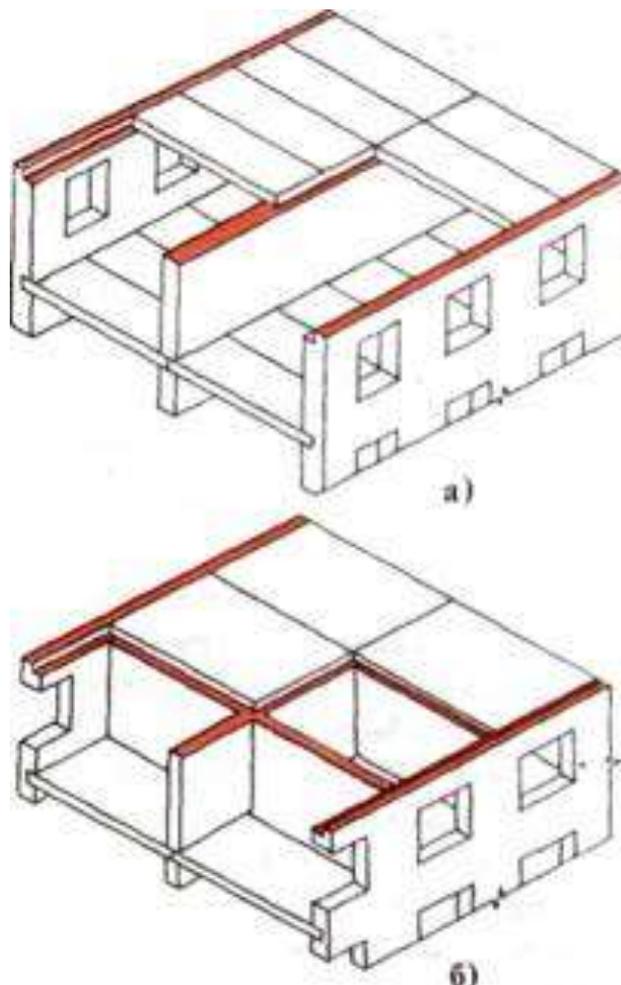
Конструктивные схемы бескаркасных зданий
